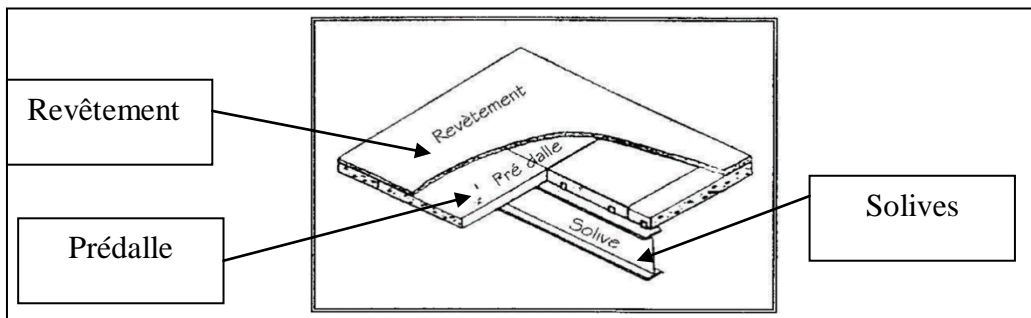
Plancher non collaborant avec pré dalles en Béton armé.⁴¹
